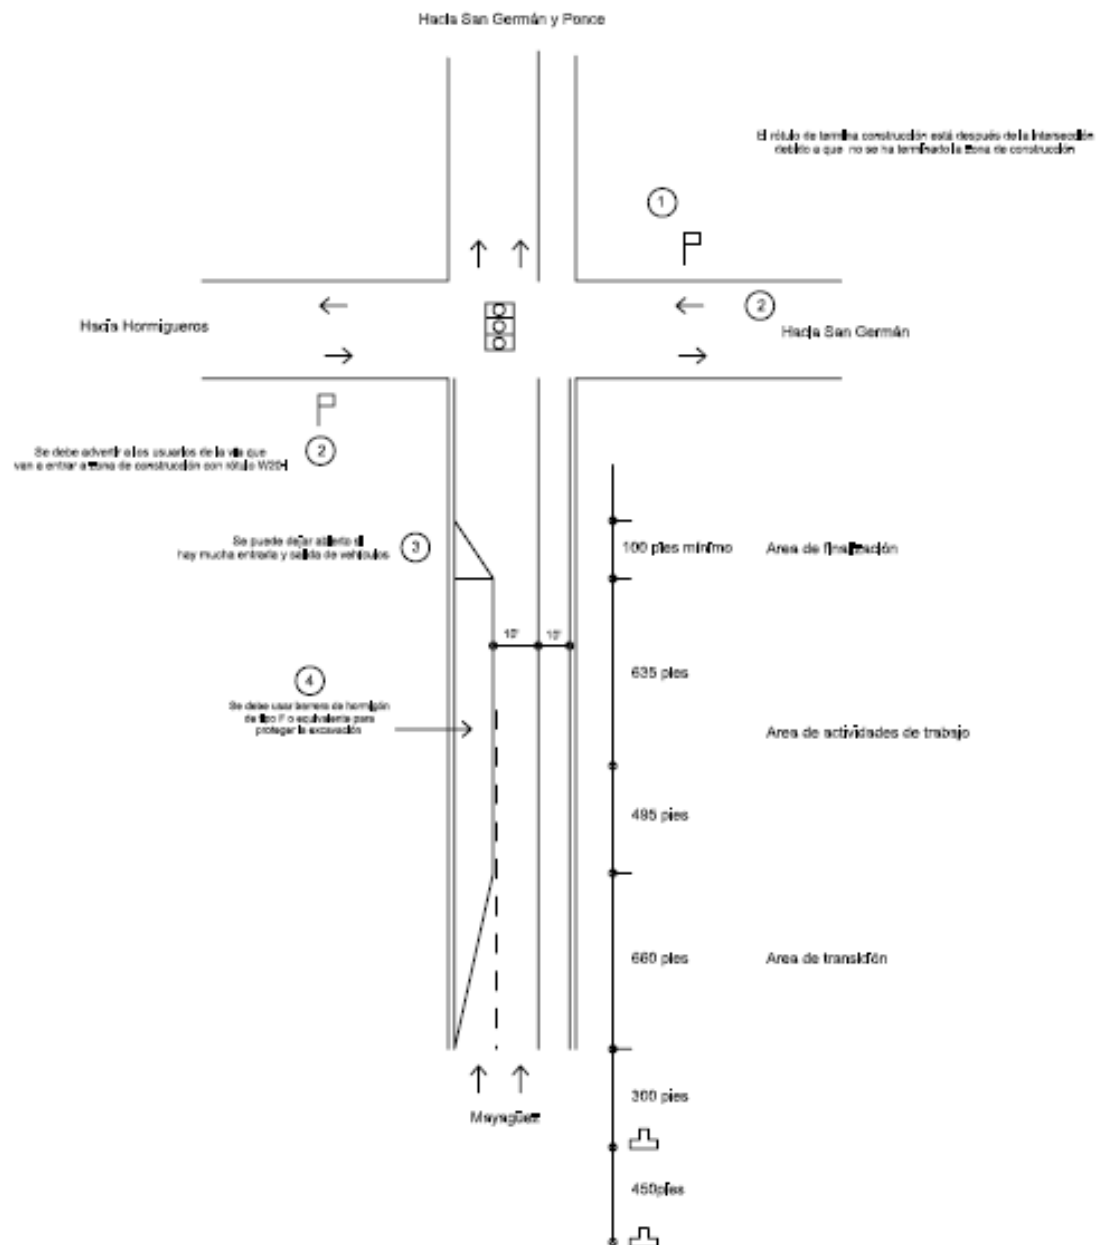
Posible diseño carretera PR-2 Km 163 al Km 165 para las zonas de construcción, hormigueros
